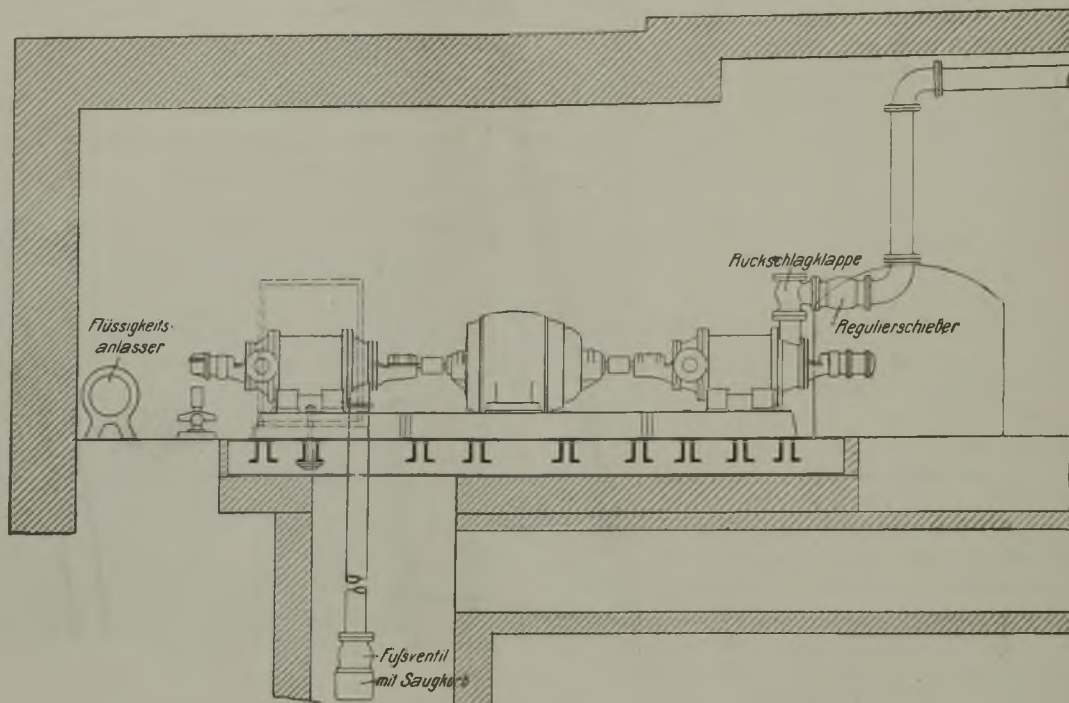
Pumpenanlage der Zeche Dorstfeld.
